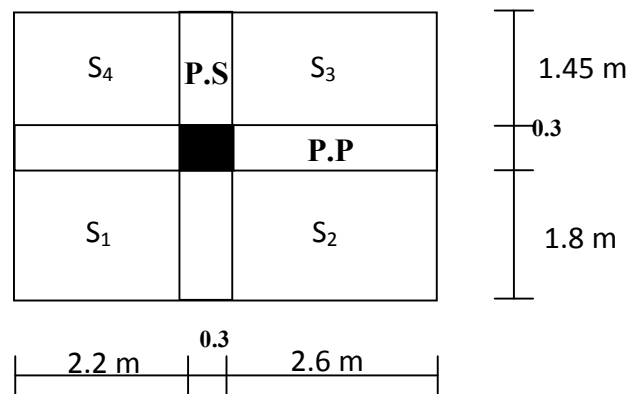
aire du plancher revenant au poteau le plus charge (C-2)
